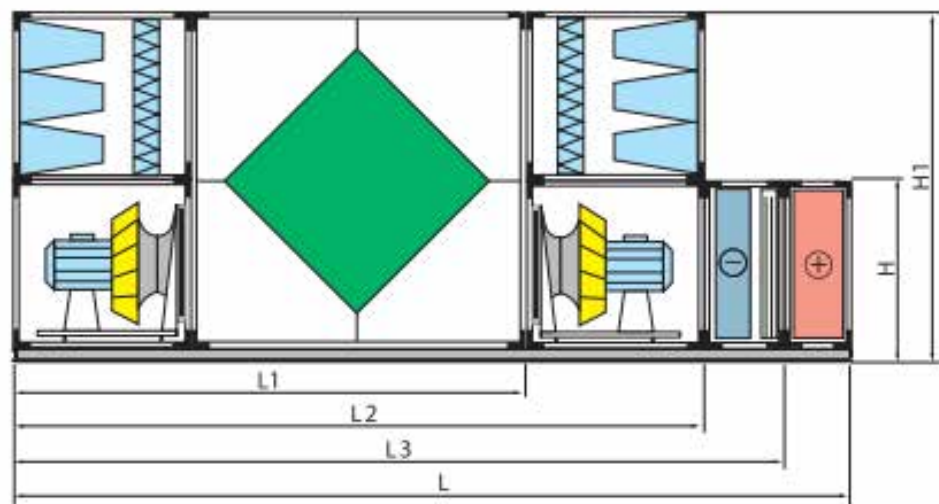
Конструктивна схема припливно–витяжного агрегату з пластинчатим рекуператором:
